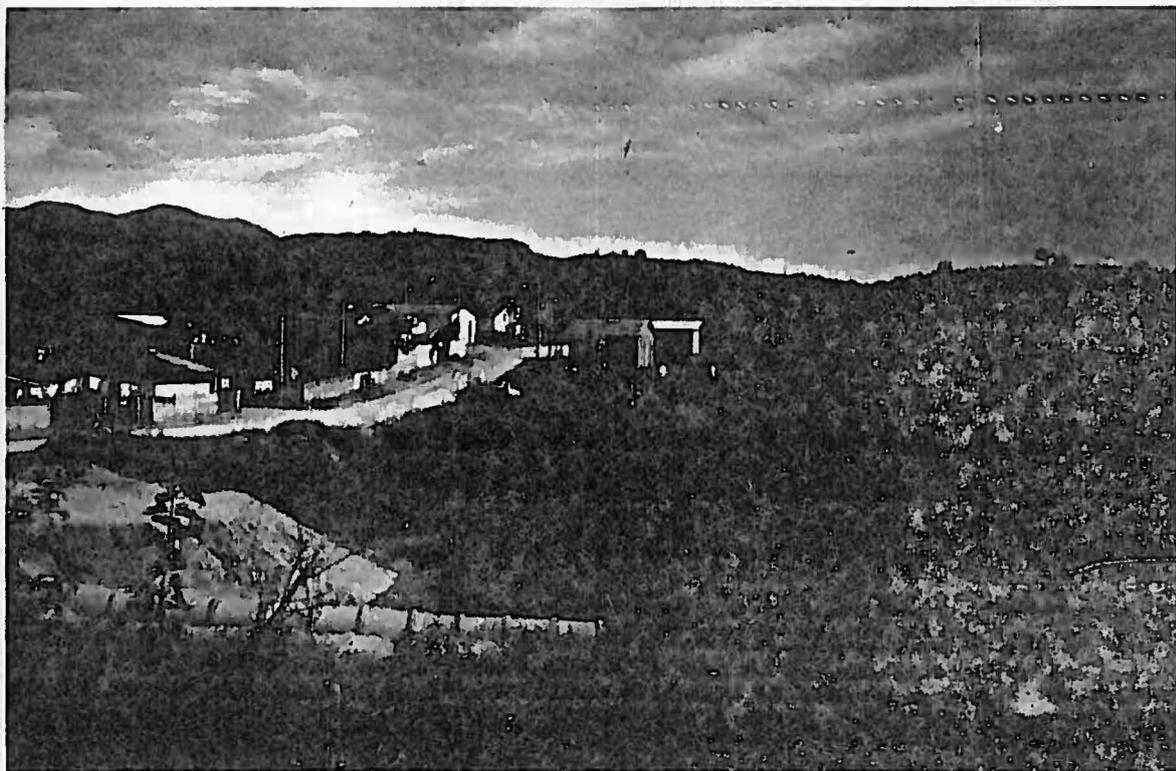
Drenagem, aterro sobre a mesma e casas com pilares altos para sustentação.
